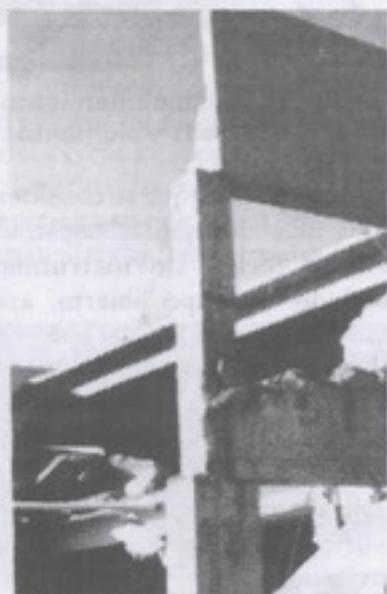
Apoyo simple de vigas prefabricadas. La conexión no es capaz de proveer continuidad y transmitir momentos de flexión. Se observa la dimensión precaria del apoyo y la ausencia de dispositivos para asegurar la integridad estructural de la obra.
